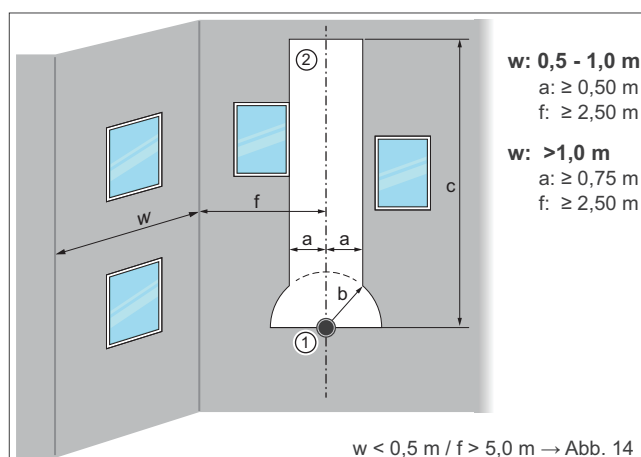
Mündungen an Gebäudefassaden (Anordnung an Querfassade)
